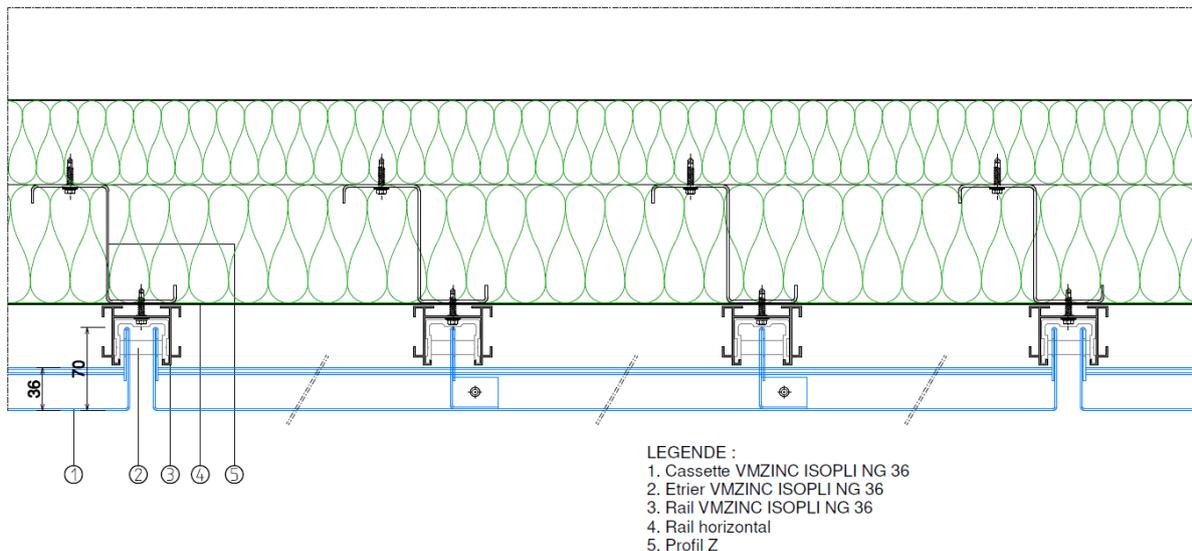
Cassettes horizontales sur plateaux. Coupe horizontale
